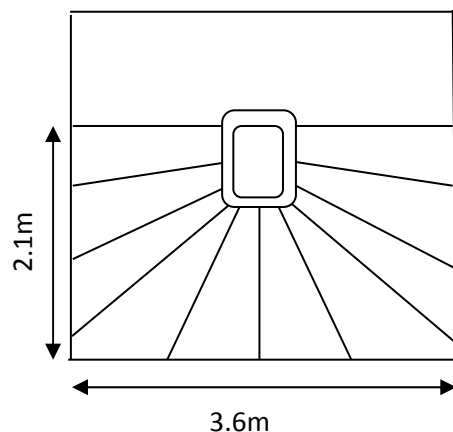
Vue en plan d'escalier tournant avec palier de repos
